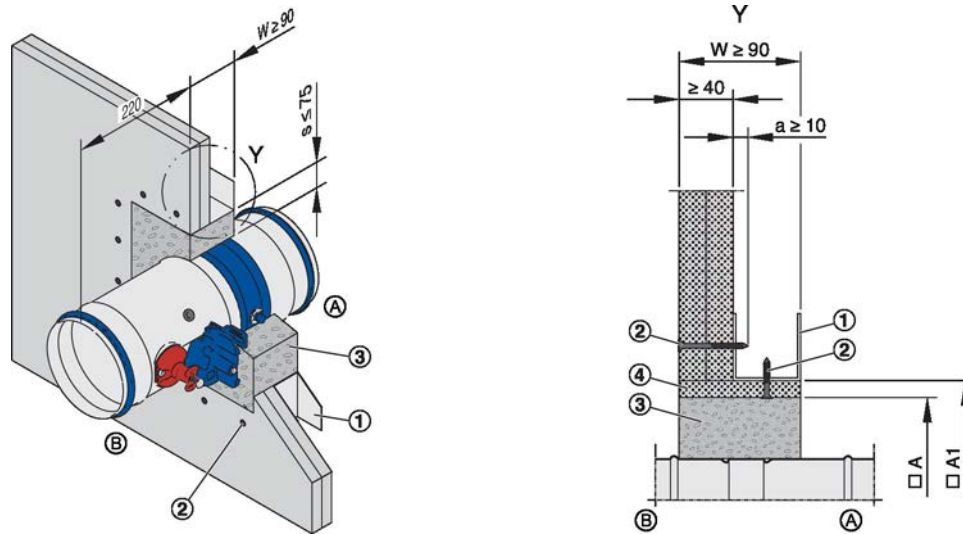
Instalación con mortero en patinillos con estructura de pared metálica
